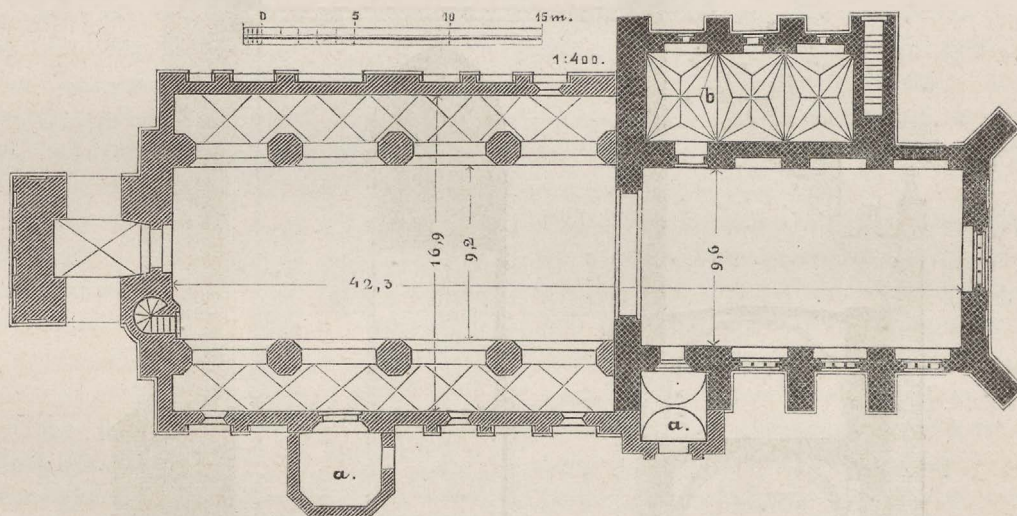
Schwetz. Grundriss der kath. Pfarrkirche.
